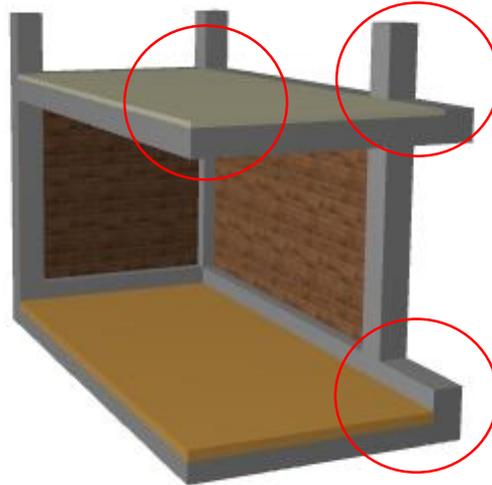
3D Armazón de vigas y columnas con recubrimiento de concreto pobre.
